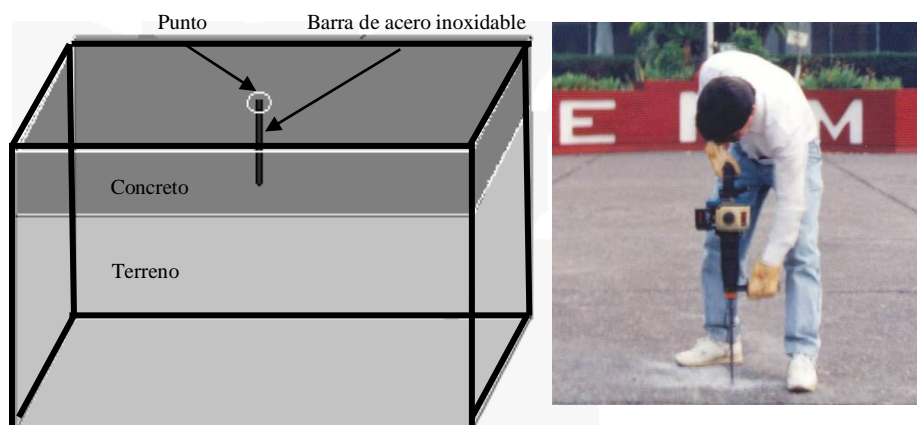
Mojonera tipo plancha de concreto en la Benemérita Escuela Nacional de Maestros.
